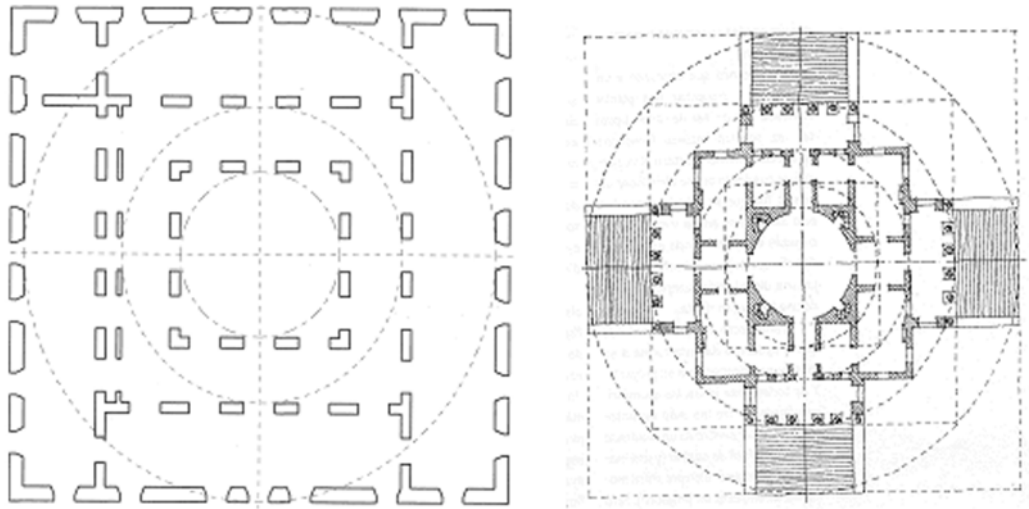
Esquema estructural de Carrascalejo y de Villa Palladio.
